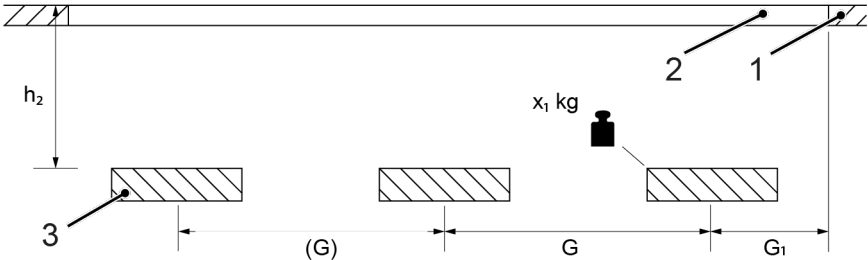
Sous-structure de la plaque chauffante (exemple : WHP GN 3/1)
